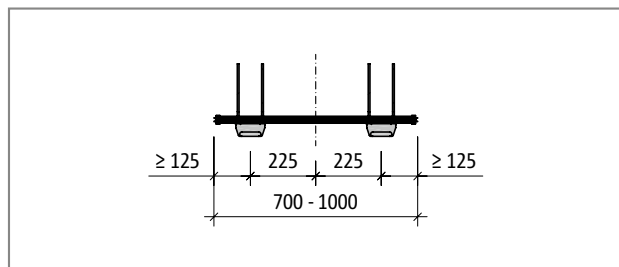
Schöck Tronsole® tipo T-V2-H...-L700 - L1000, pianta del prodotto
